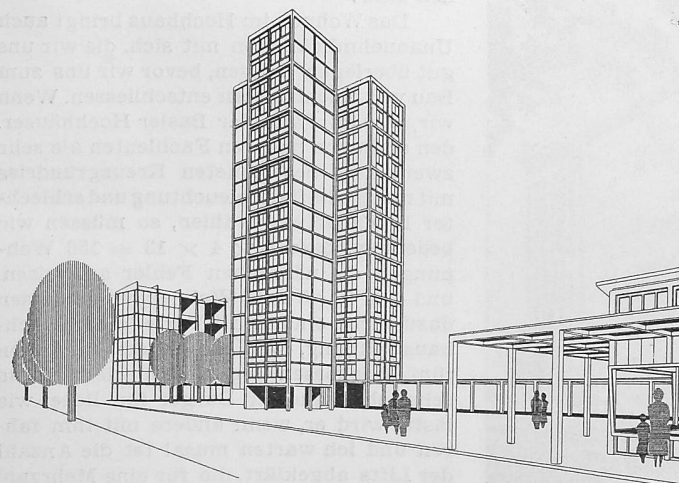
und 11. Entwurf für ein Wohnhochhaus in Budapest
